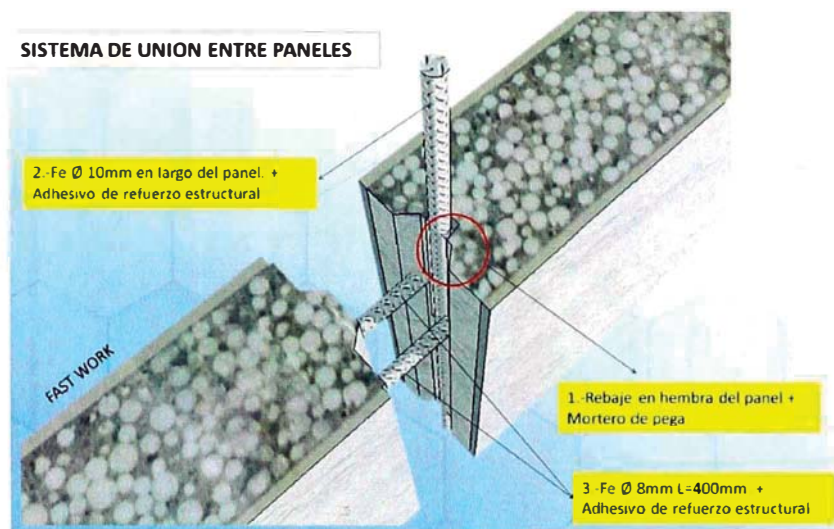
Detalle de colocación de anclajes en la unión de dos paneles
